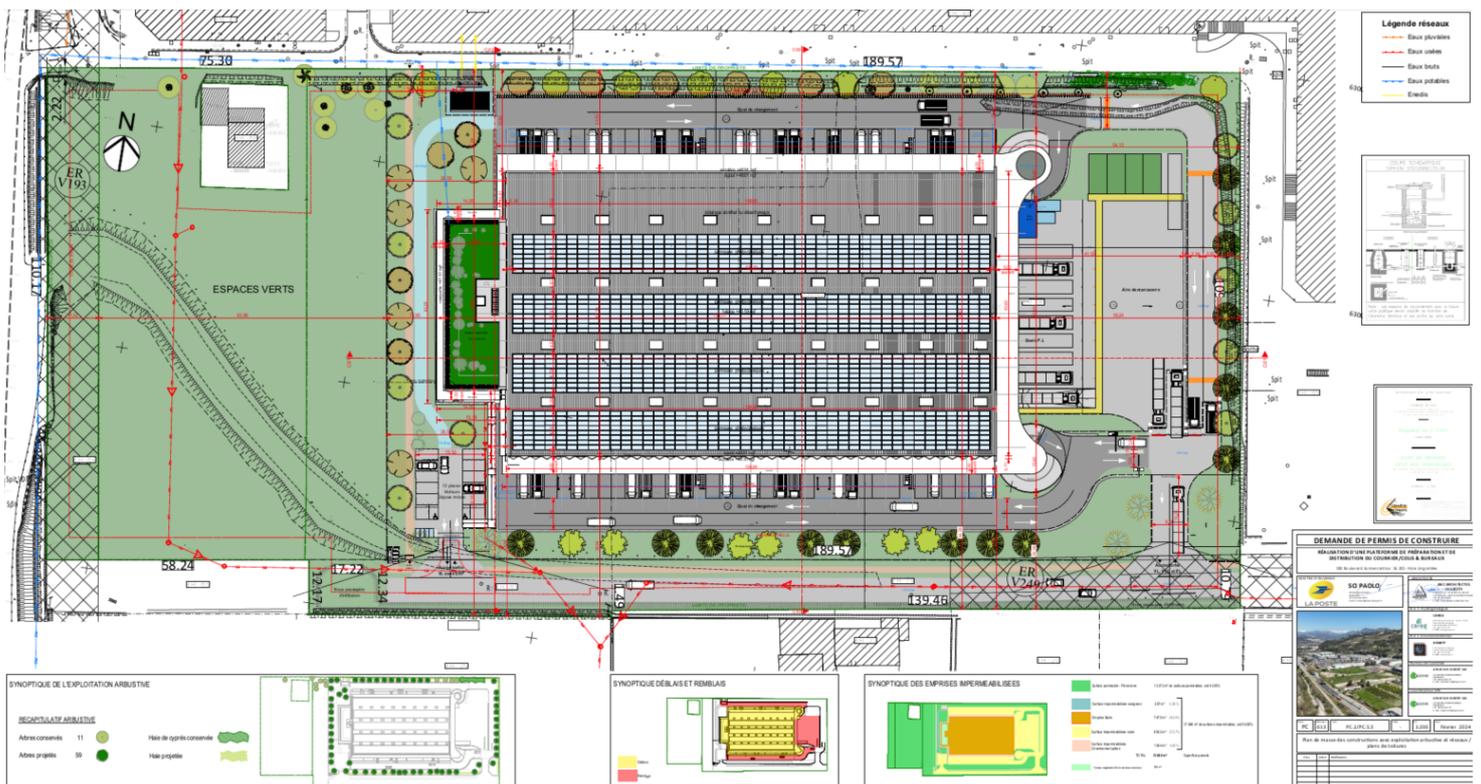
PLAN DE MASSE DU PROJET ACTUEL (SOURCE : ABC ARCHITECTES)
